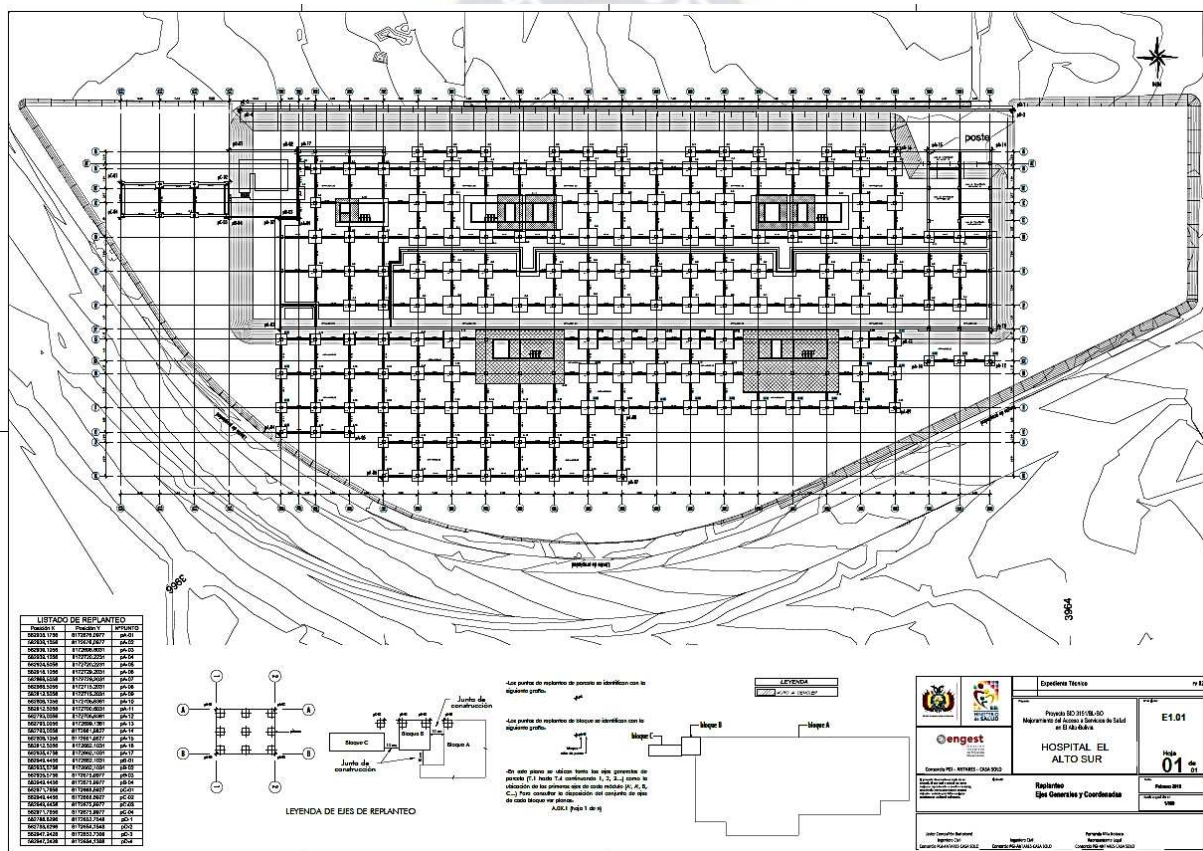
PLANO DE UBICACIÓN DE ZAPATAS HOSPITAL DEL SUR – EL ALTO
